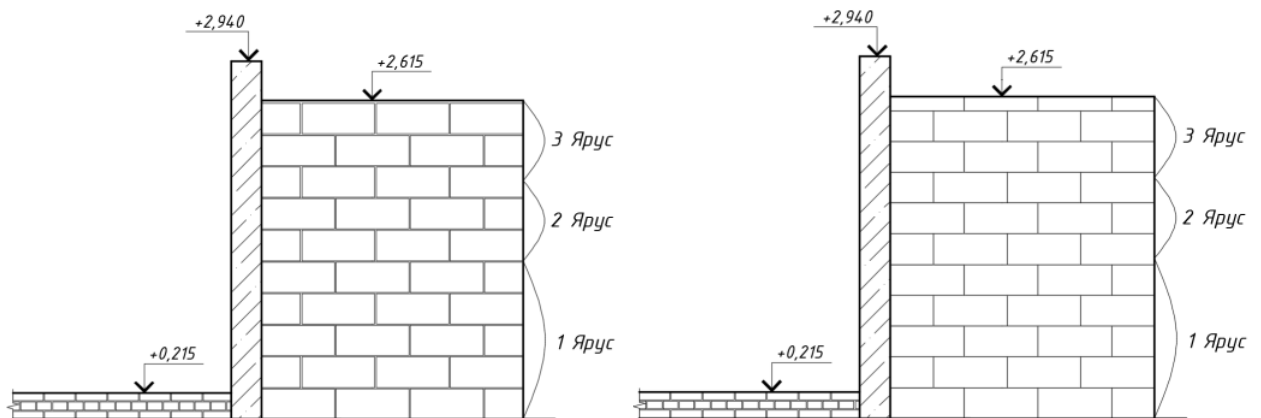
Фрагмент стены для 4-6 сравниваемые варианты возведения стены
